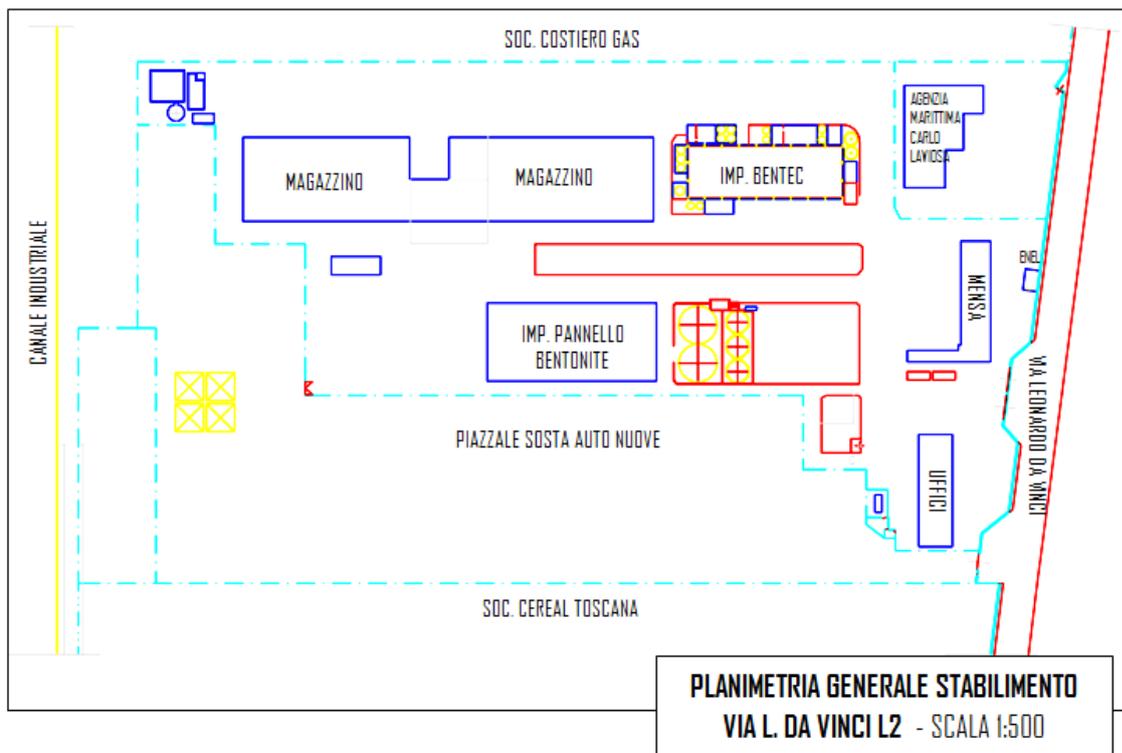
Planimetria generale stabilimento Via L. Da Vinci L2
